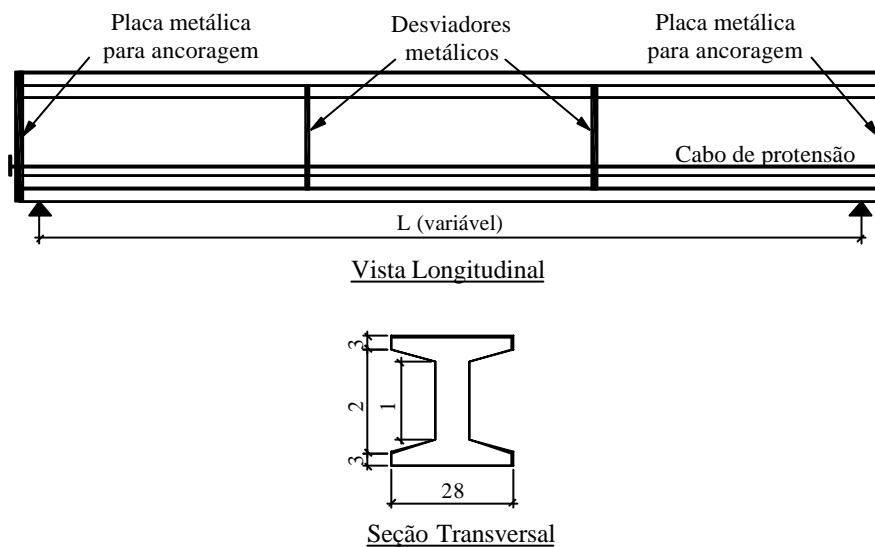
Vista longitudinal e seção transversal das vigas ensaiadas por BRANCO (1993) e ARAÚJO (1997)
